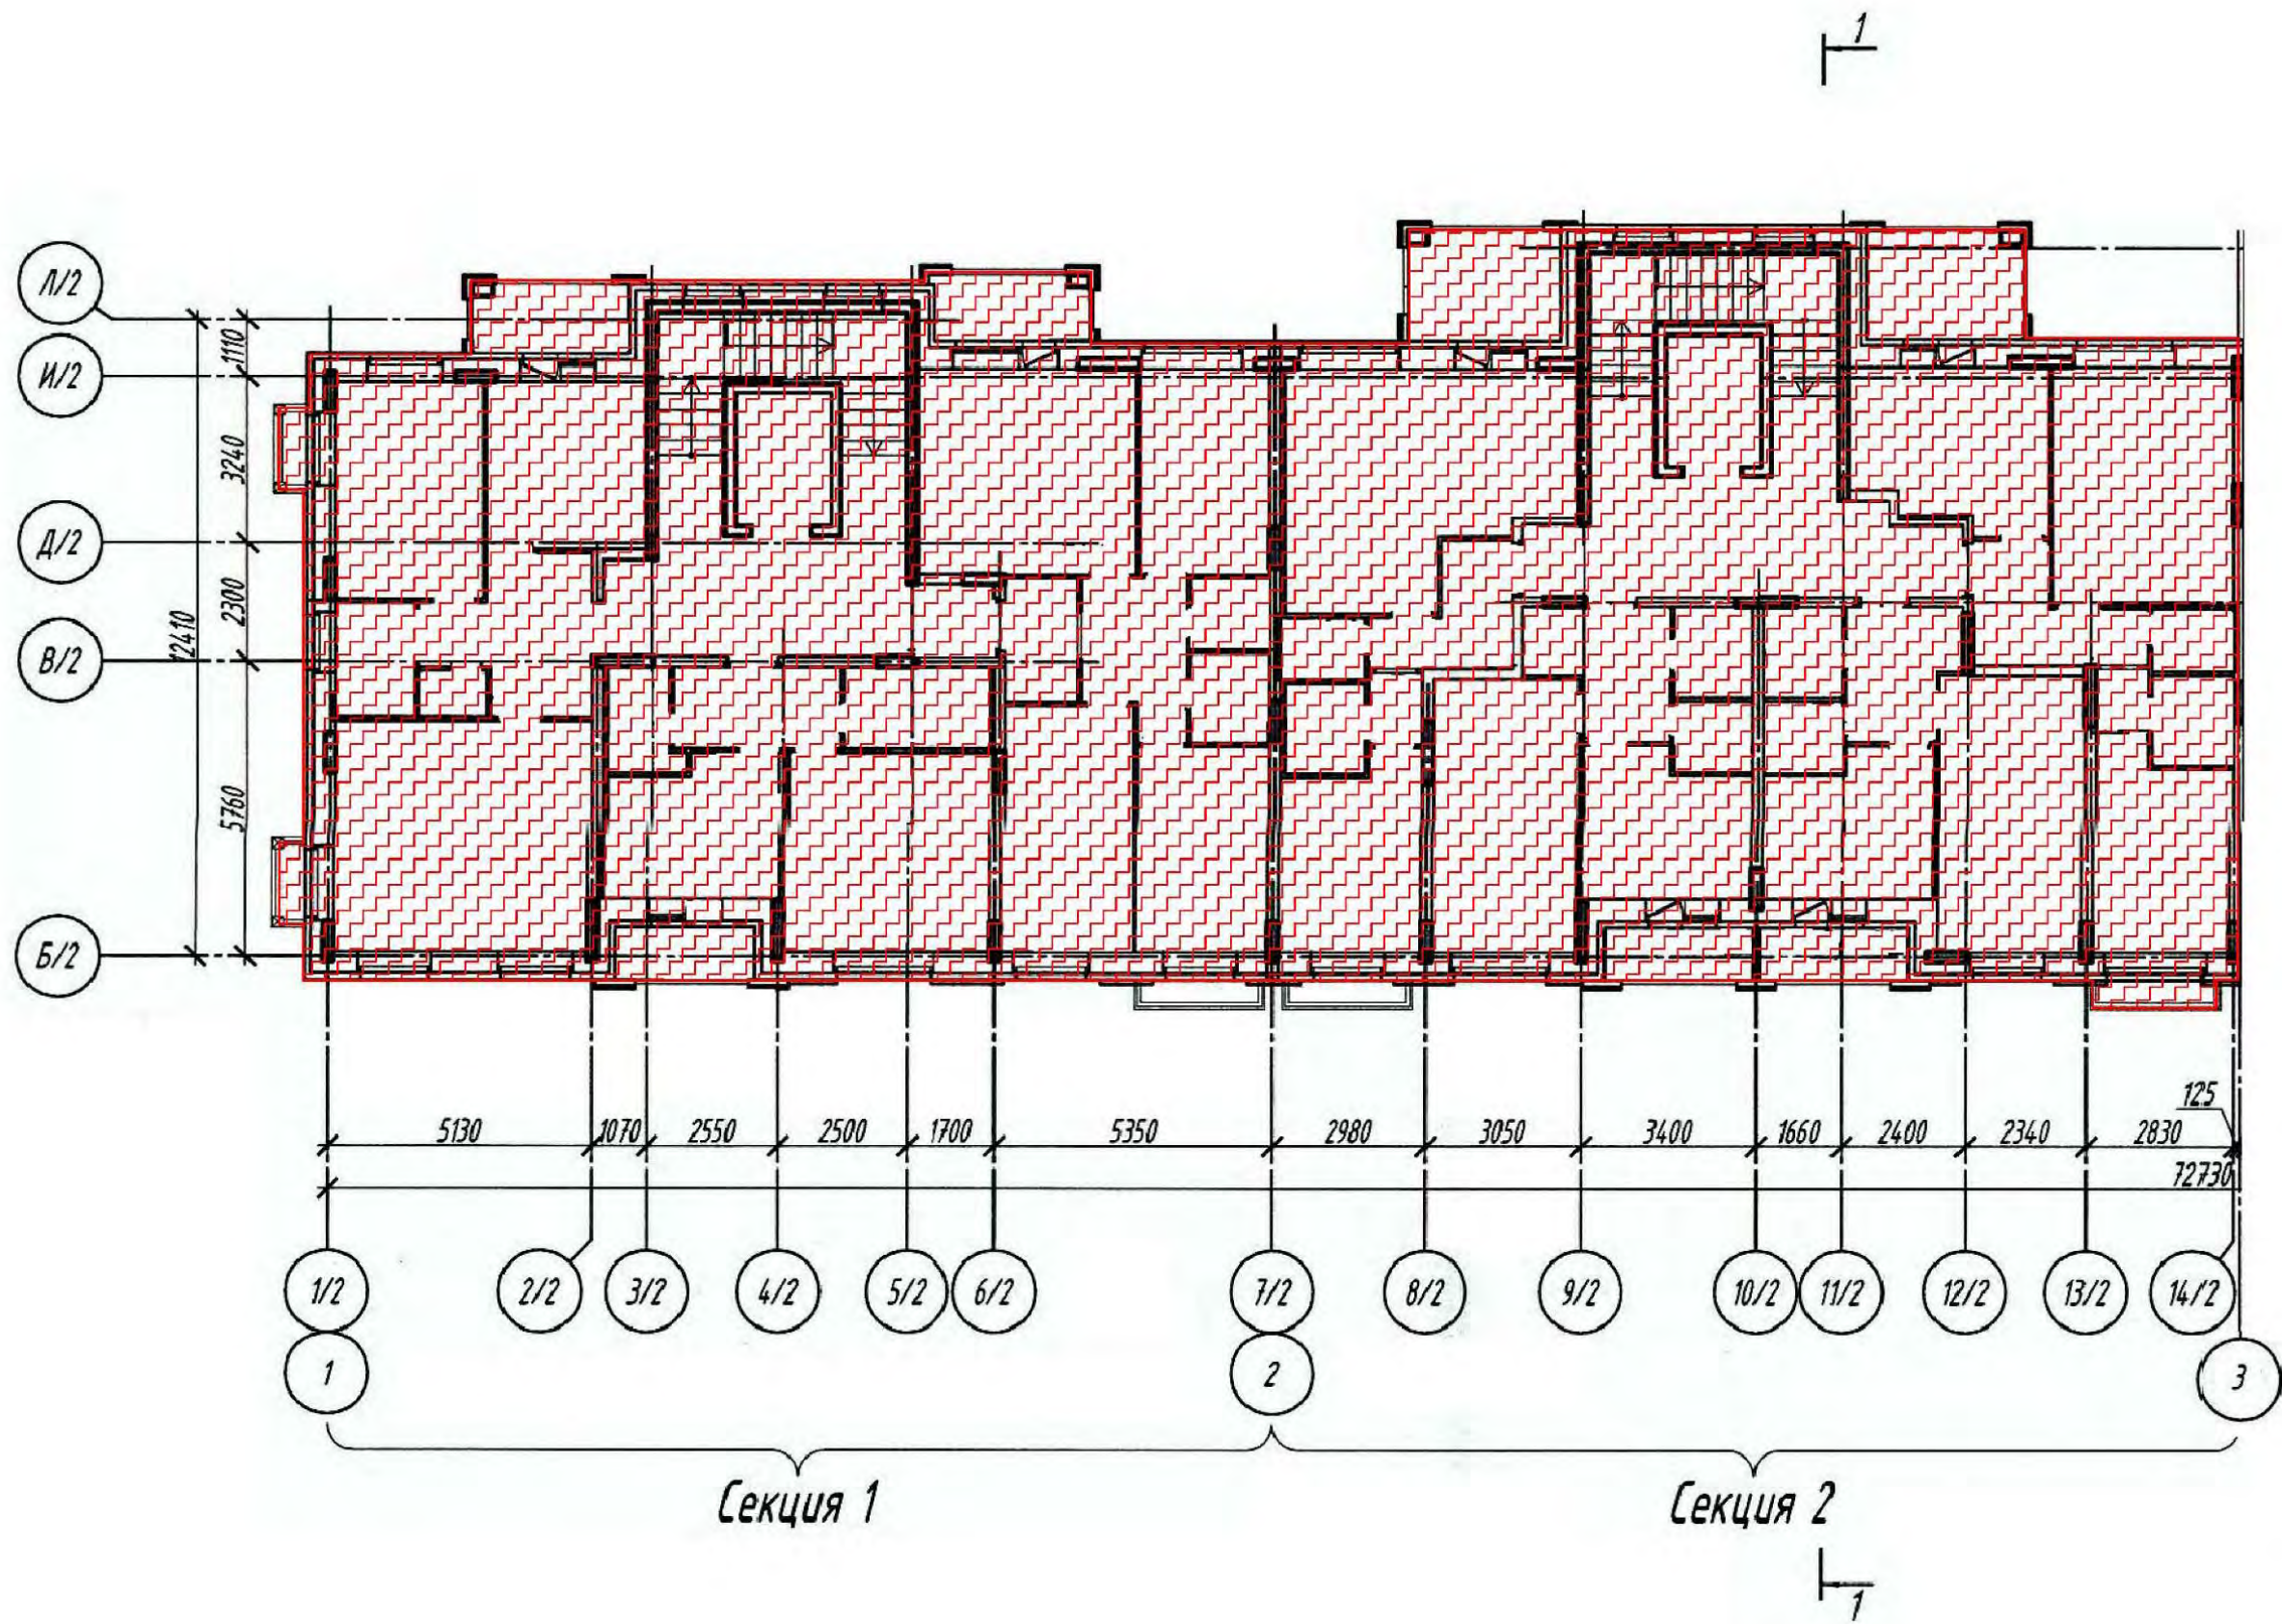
Участки непроектного класса бетона плиты перекрытия 2-го этажа (см. приложение №2 протоколы испытания)
